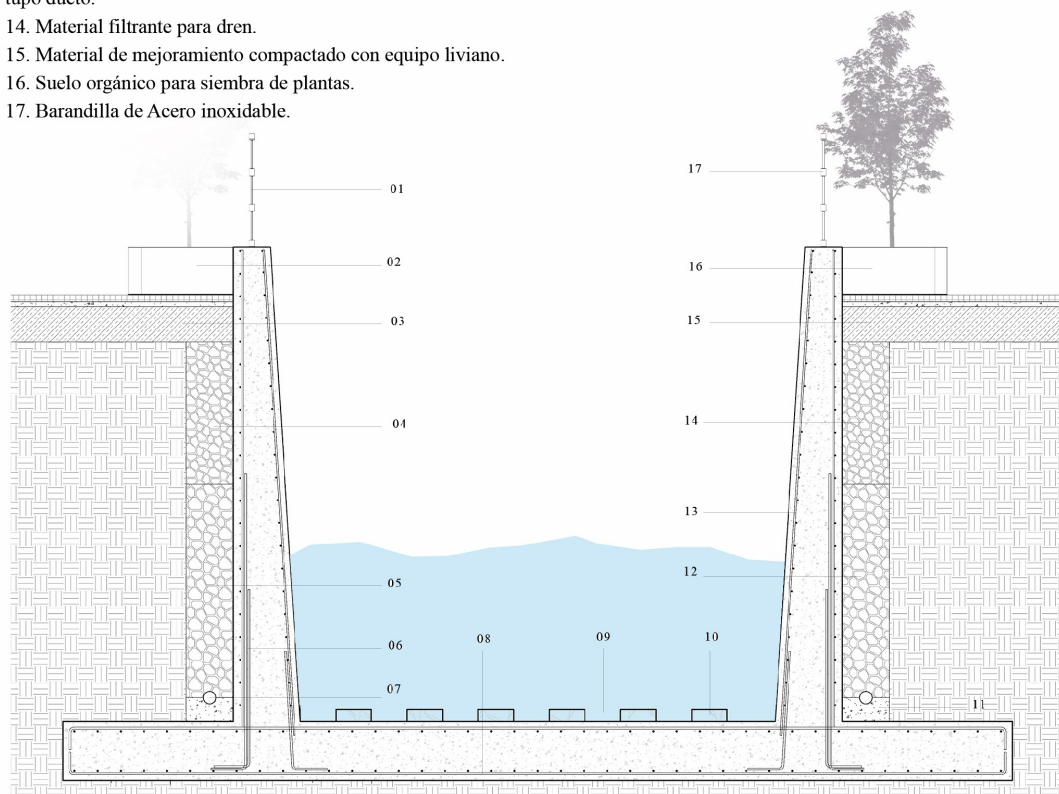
Análisis del sistema constructivo de muro de contención. Elaboración: Autoras.
